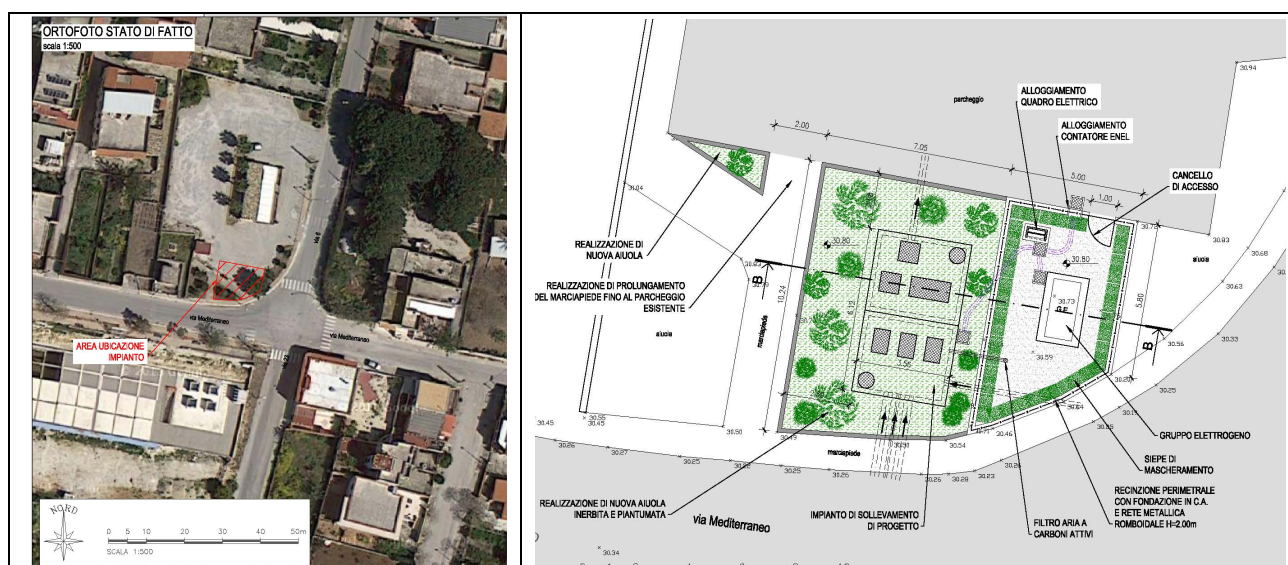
Localizzazione territoriale dell'impianto e planimetria con le sistemazioni previste.
